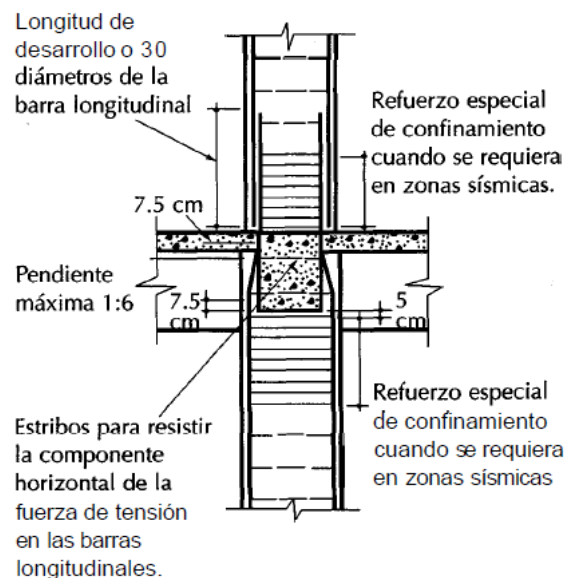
Detalles del refuerzo en los cambios de sección de columnas.
